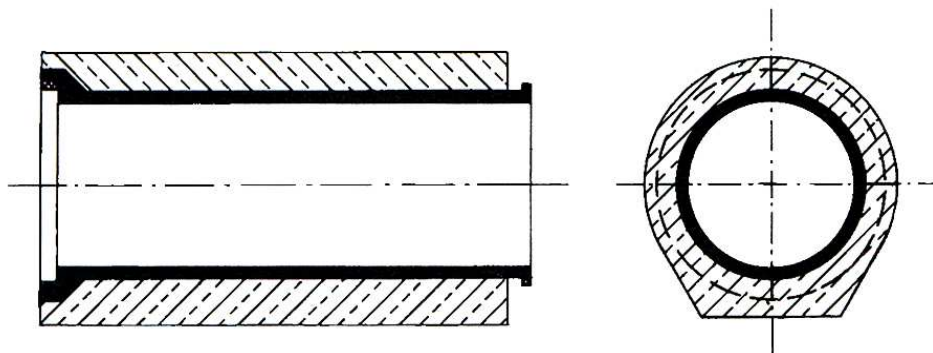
Бетонно-керамическая труба (БК-Rohr - Керамическое общество с ограниченной ответственностью): а) вид трубного соединения; б) продольный разрез по трубному соединению.
